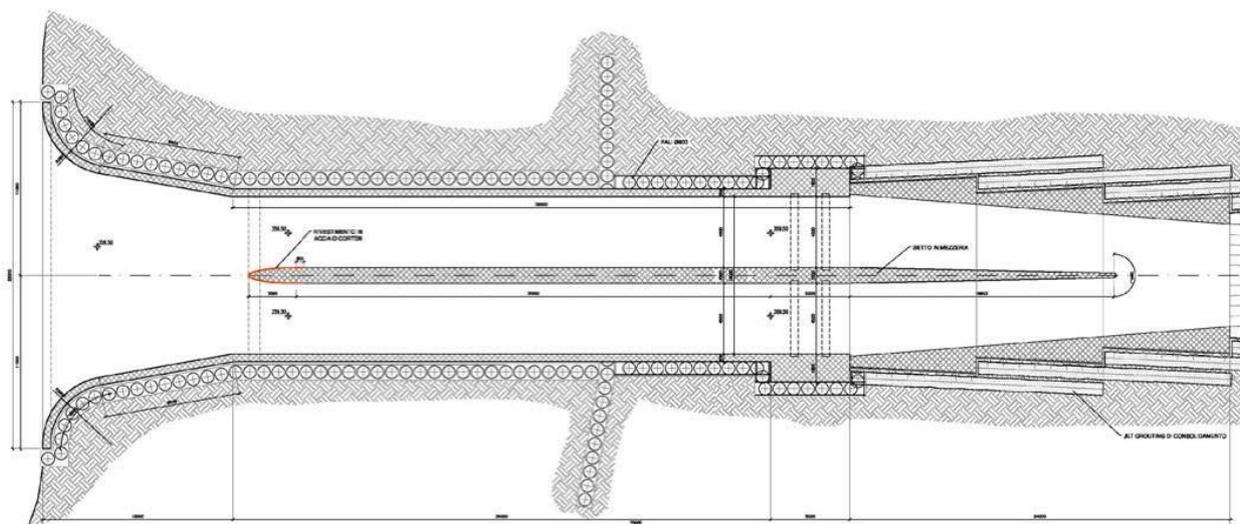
Planimetria dell'opera di imbocco in PD (Elaborato: D\_DP\_ST\_IMB\_T\_009\_2)
